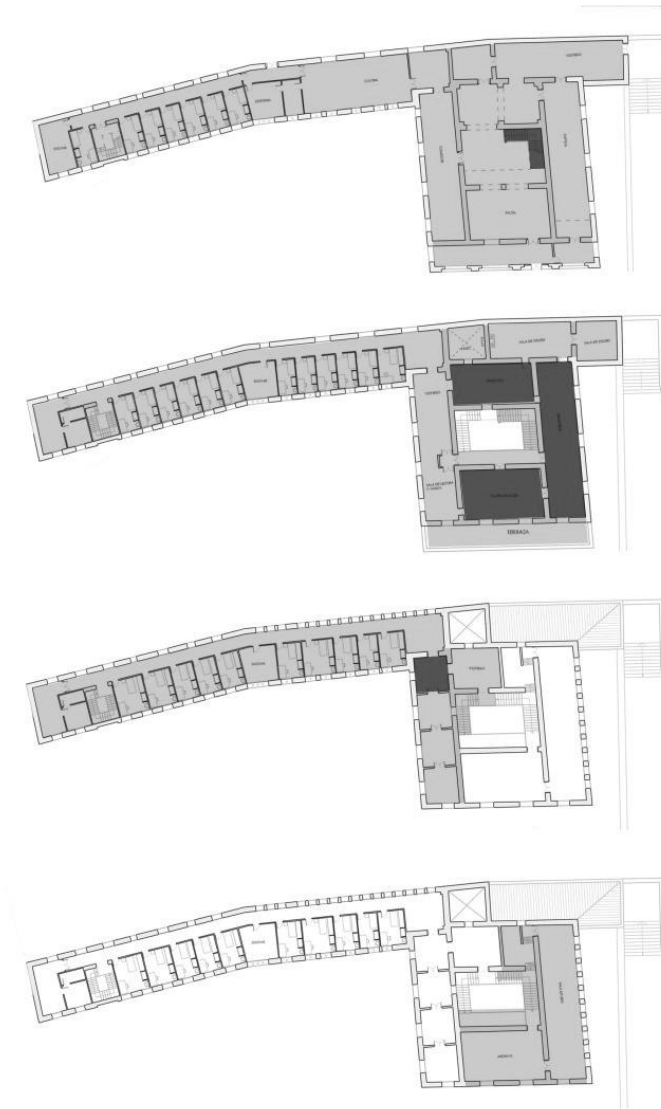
Levantamiento gráfico del castillo de Burjassot. De arriba a abajo: planta baja, planta primera, planta intermedia segunda, planta segunda. (Imagen de archivo de la UPV).
